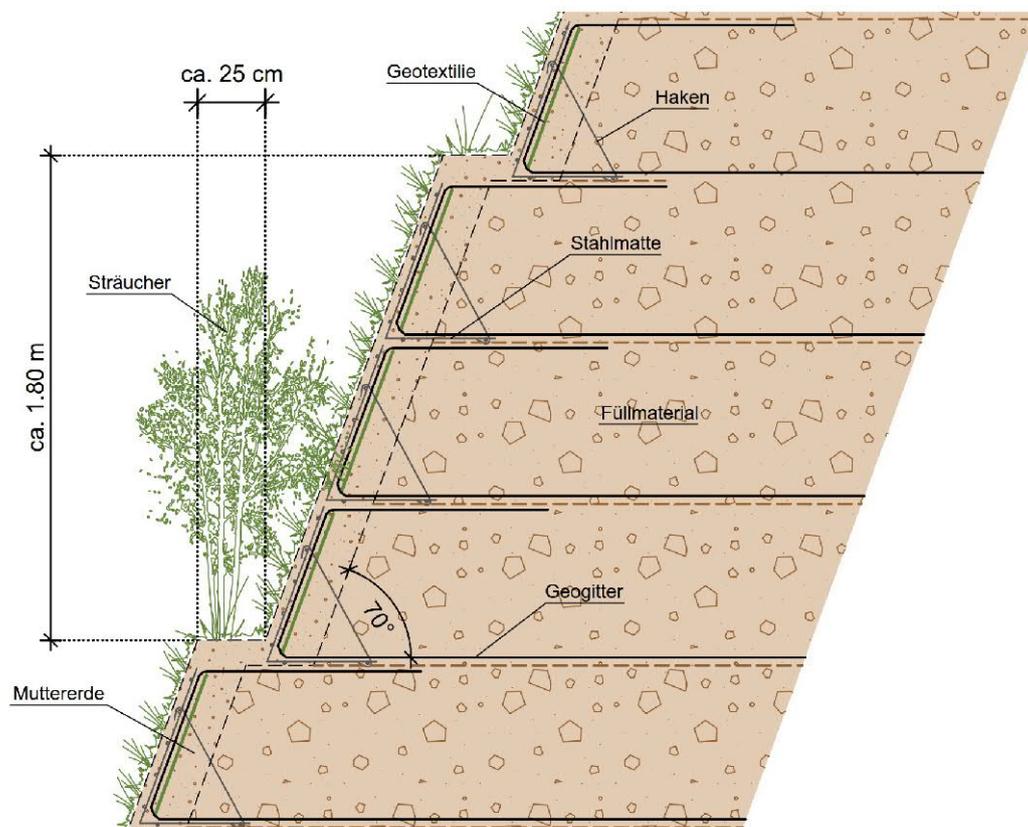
Ausführungsdetail bewehrte Erde - Schnitt mit Bermen
